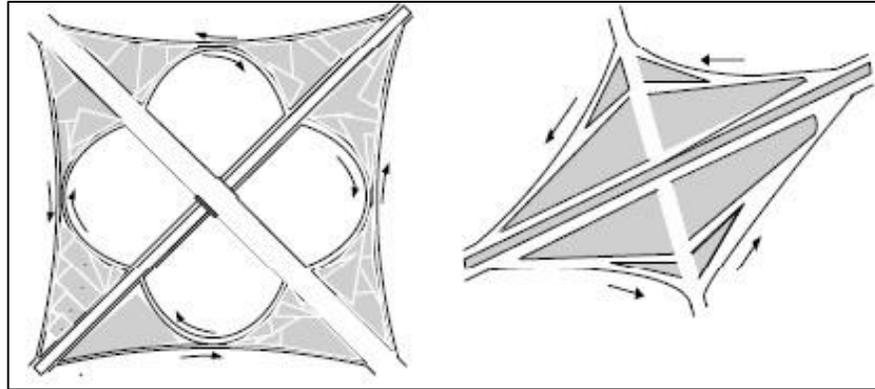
Prinsip rerouting pada jaringan jalan.
